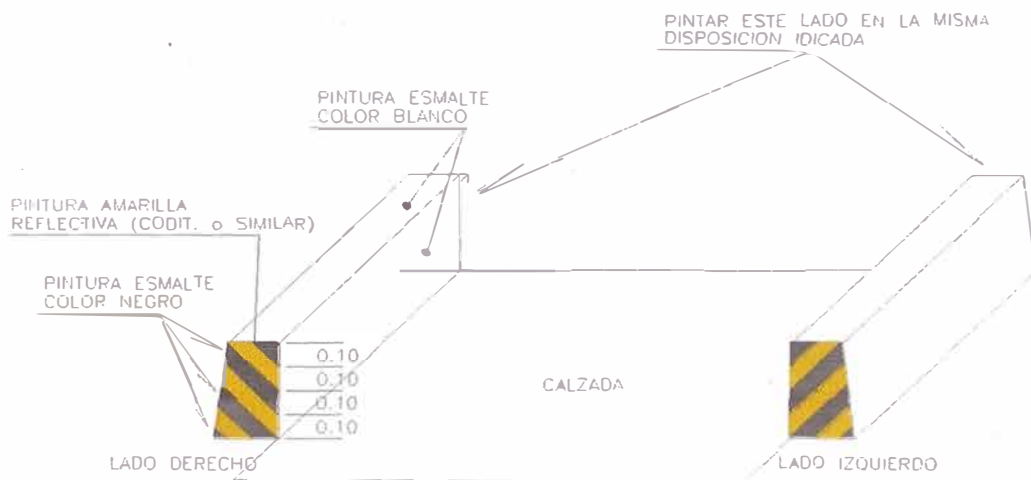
Detalle de Pintado de Parapetos de Alcantarillas y Pontones
